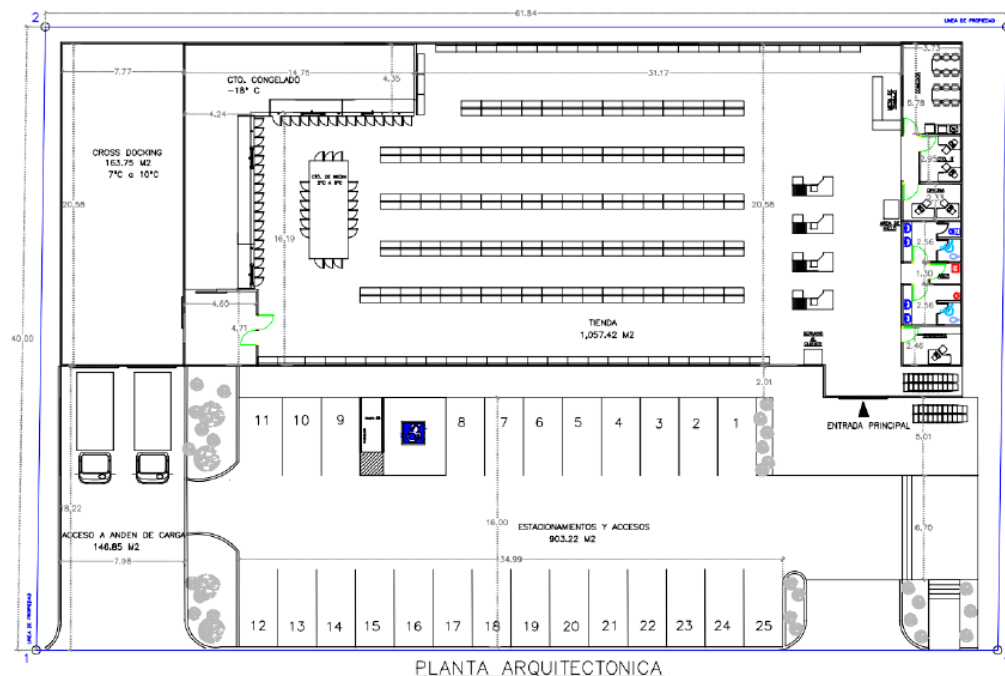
Planta arquitectónica de la infraestructura a construir. Fuente: Planos del Proyecto.
